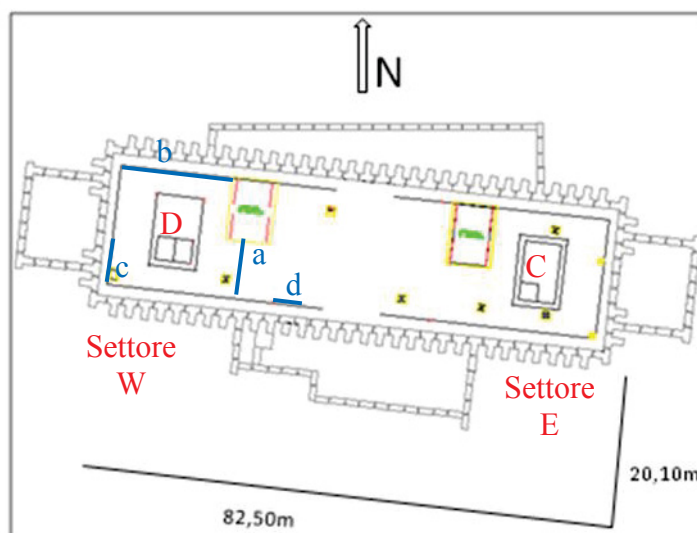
Pianta del Cantiere “San Pasquale” e ubicazione delle sezioni di dettaglio ricostruite illustrate di seguito.
